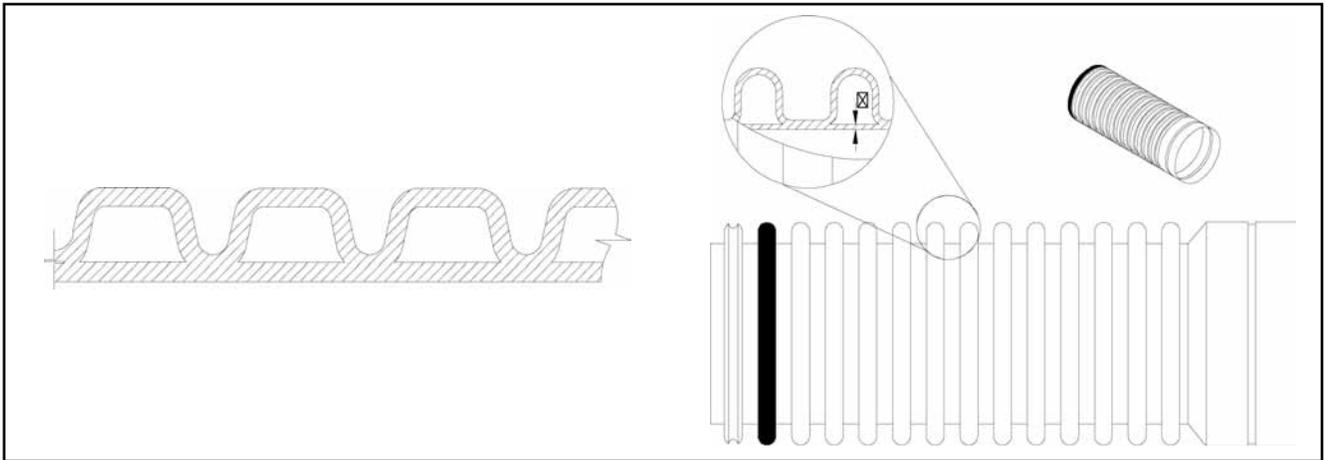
Tubería de pared estructurada de perfil cerrado
